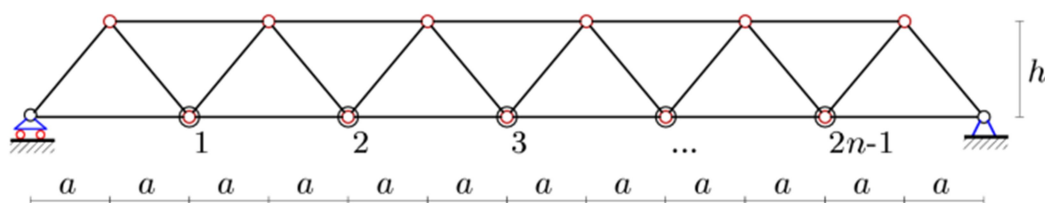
Ферма с треугольной решеткой, нагруженная в узлах нижнего пояса [9]
